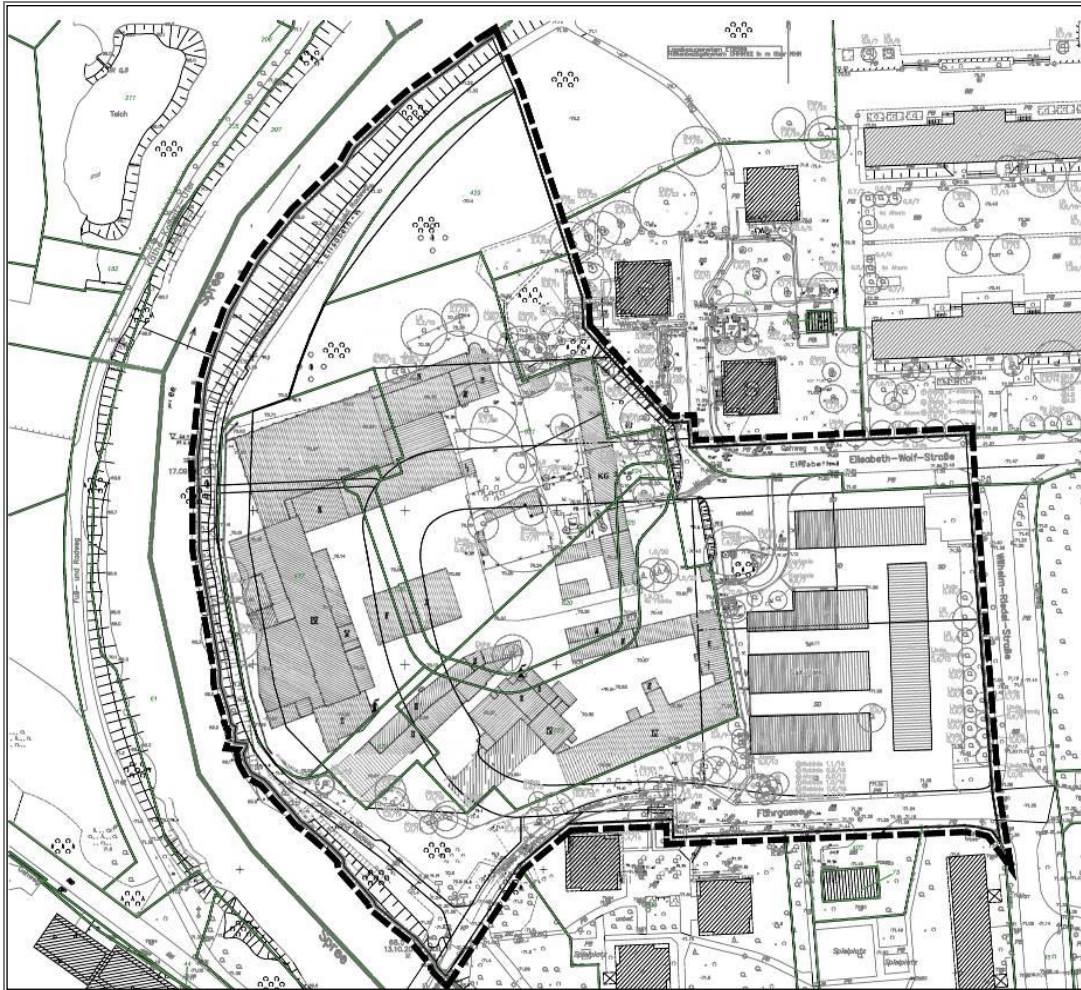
Überlagerung der ehemaligen gewerblichen Bebauung mit den Grenzen des vorliegenden Bebauungsplans
